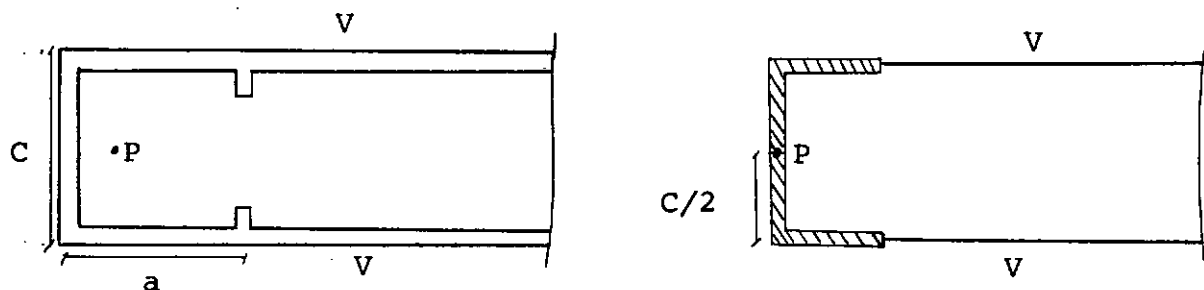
Vista em planta. Caixa resistente e sua idealização estrutural.
